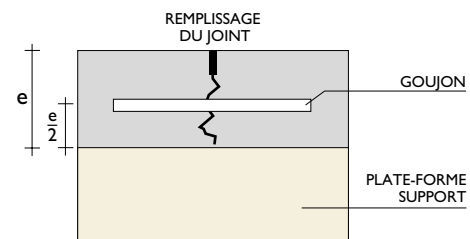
Schéma d'un joint de construction (transversal ou longitudinal)
